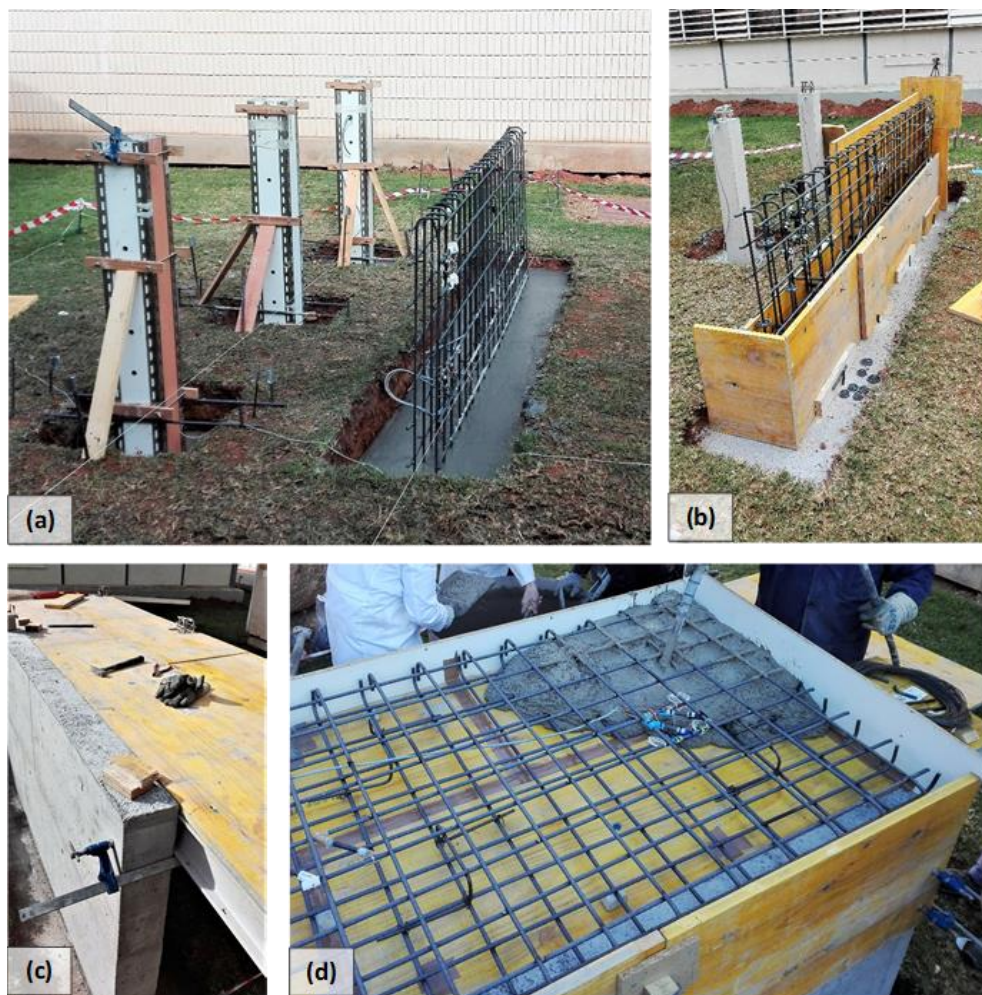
Encofrado de los pilares (a) y el muro (b). Tras su hormigonado y desencofrado se ejecuta la losa (c y d).
